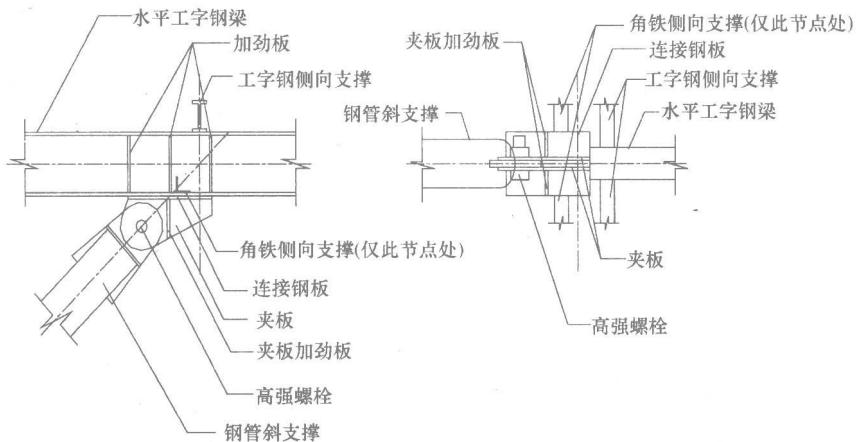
钢管斜撑与水平钢梁节点构造示意图
